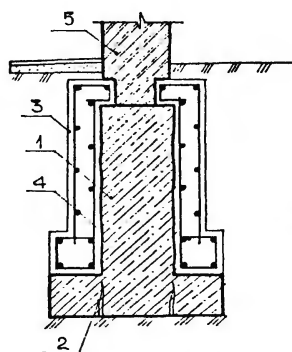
Усиление плитной части устройством железобетонной обоймы
